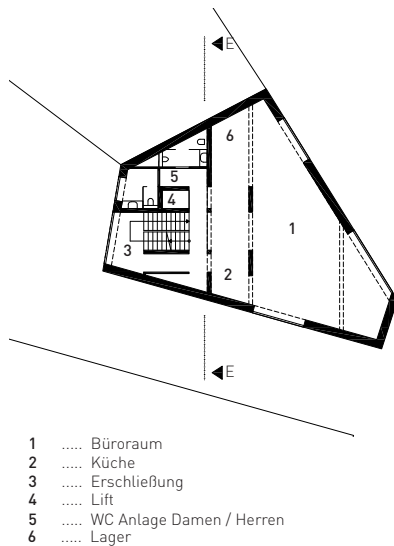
Grundriss Verwaltungsgebäude 2.OG +11,70m
